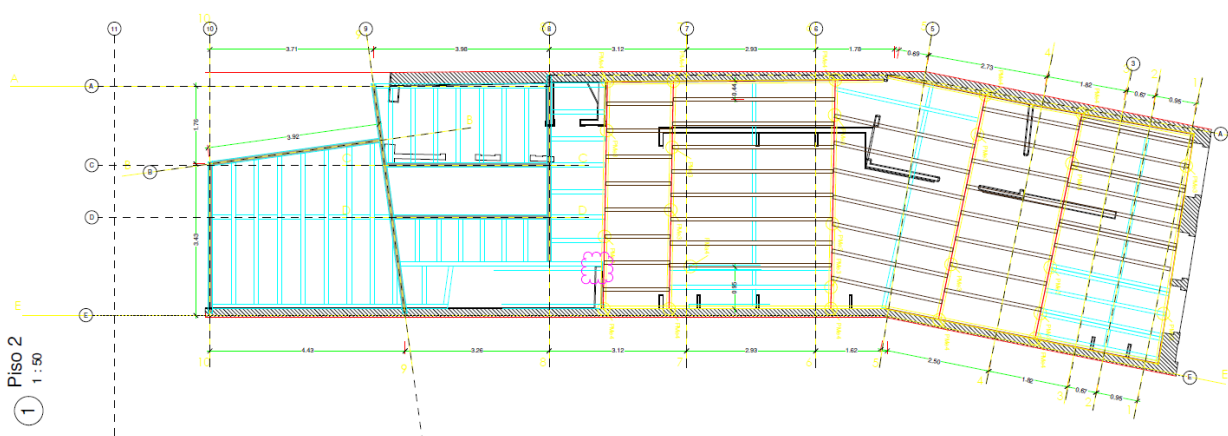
Representação da malha estrutural sobrepondo a planta importada
